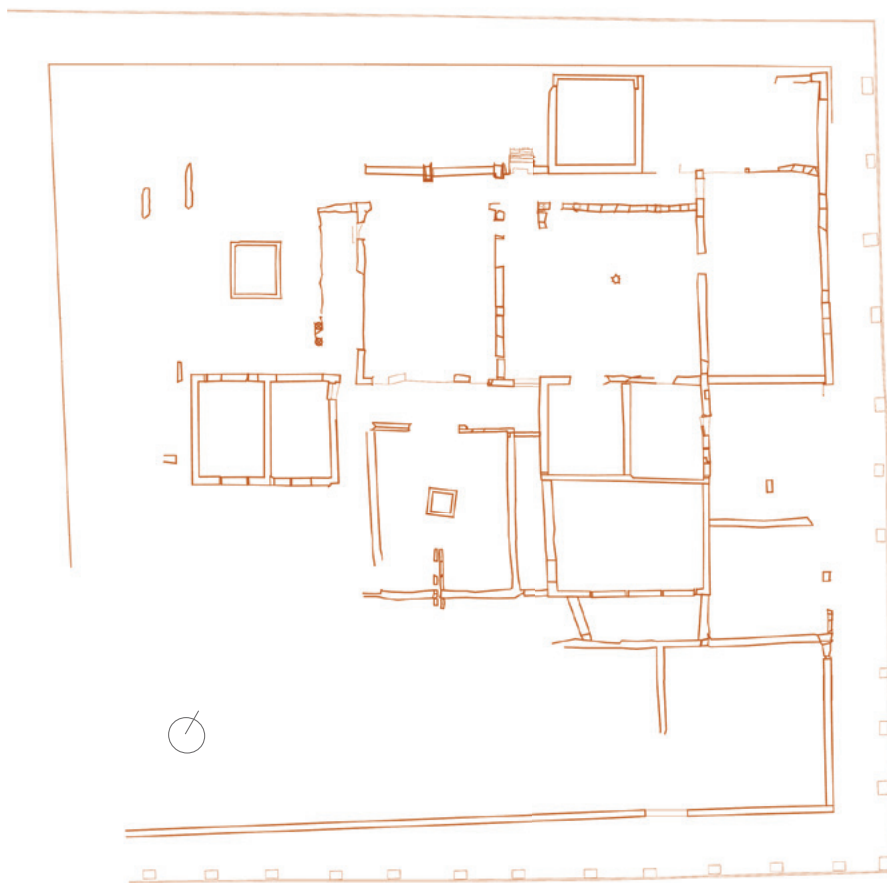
Plano del estado actual de la Casa de Hylas (fuente: R. Angulo, 2009. *Elaboración de las fichas diagnósticas de los bienes inmuebles del CAI*)
